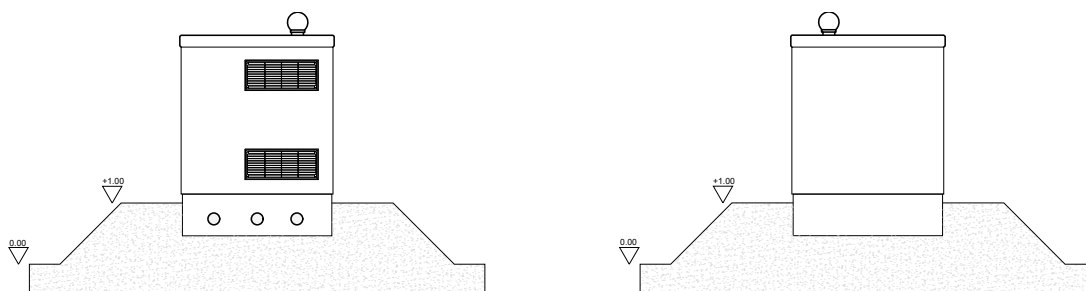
Planimetria e prospetti dell'unità di trasformazione
